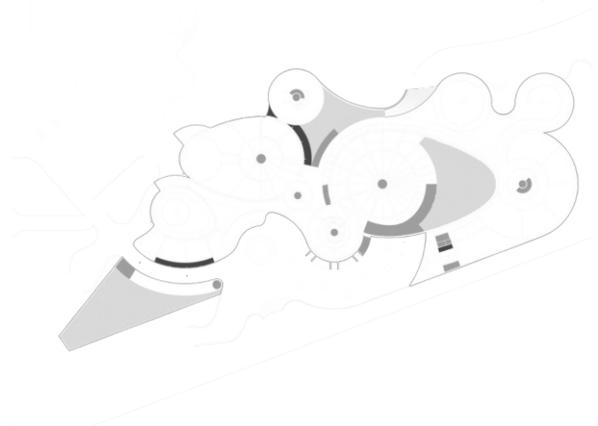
Flächennachweis. EG Grundrisse, Niveau -3,90
